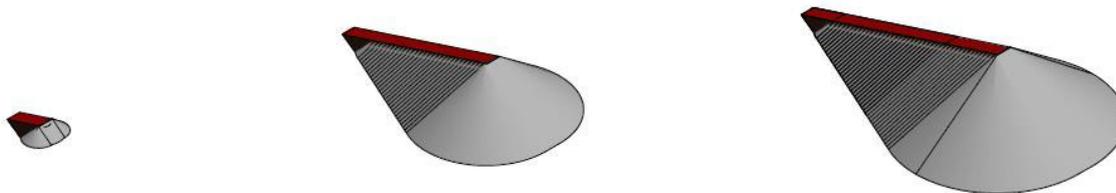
Exemplarische 3D-Ansichten der Auffahrrampe. *Links*: Der erste Rampenabschnitt aus Bauschutt sowie das erste aufgeschüttete Haufwerk. *Mitte*: Angewachsene Rampe mit abgedeckter und befestigter Rampenoberfläche. *Rechts*: Auffahrrampe in ihrer endgültigen Gestalt
